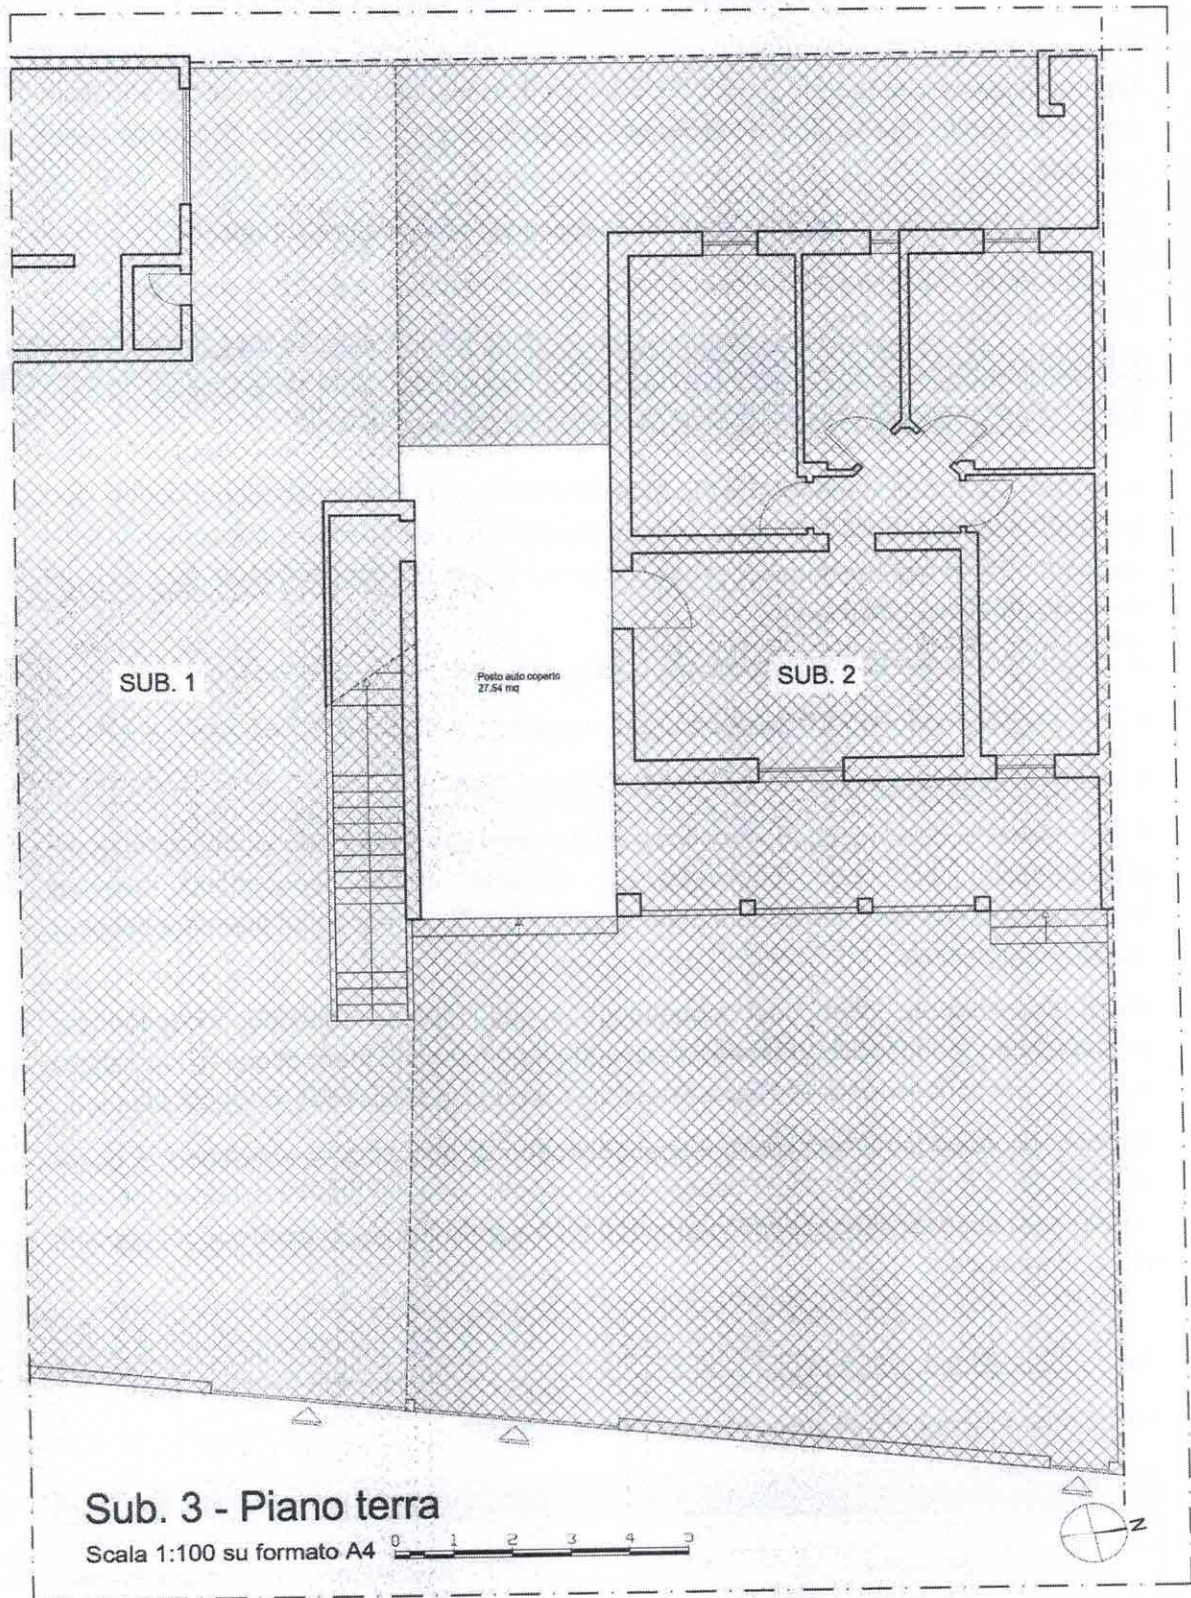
Subalterno 3 - Piano Terra - Planimetria dello stato di fatto rilevato
